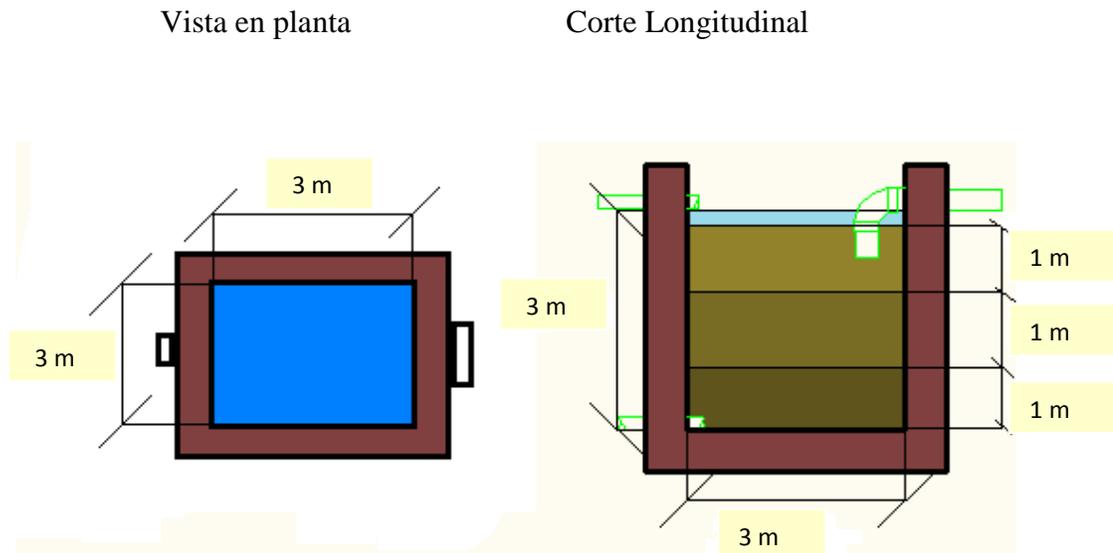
Vista planta y corte longitudinal del Filtro Vertical.
